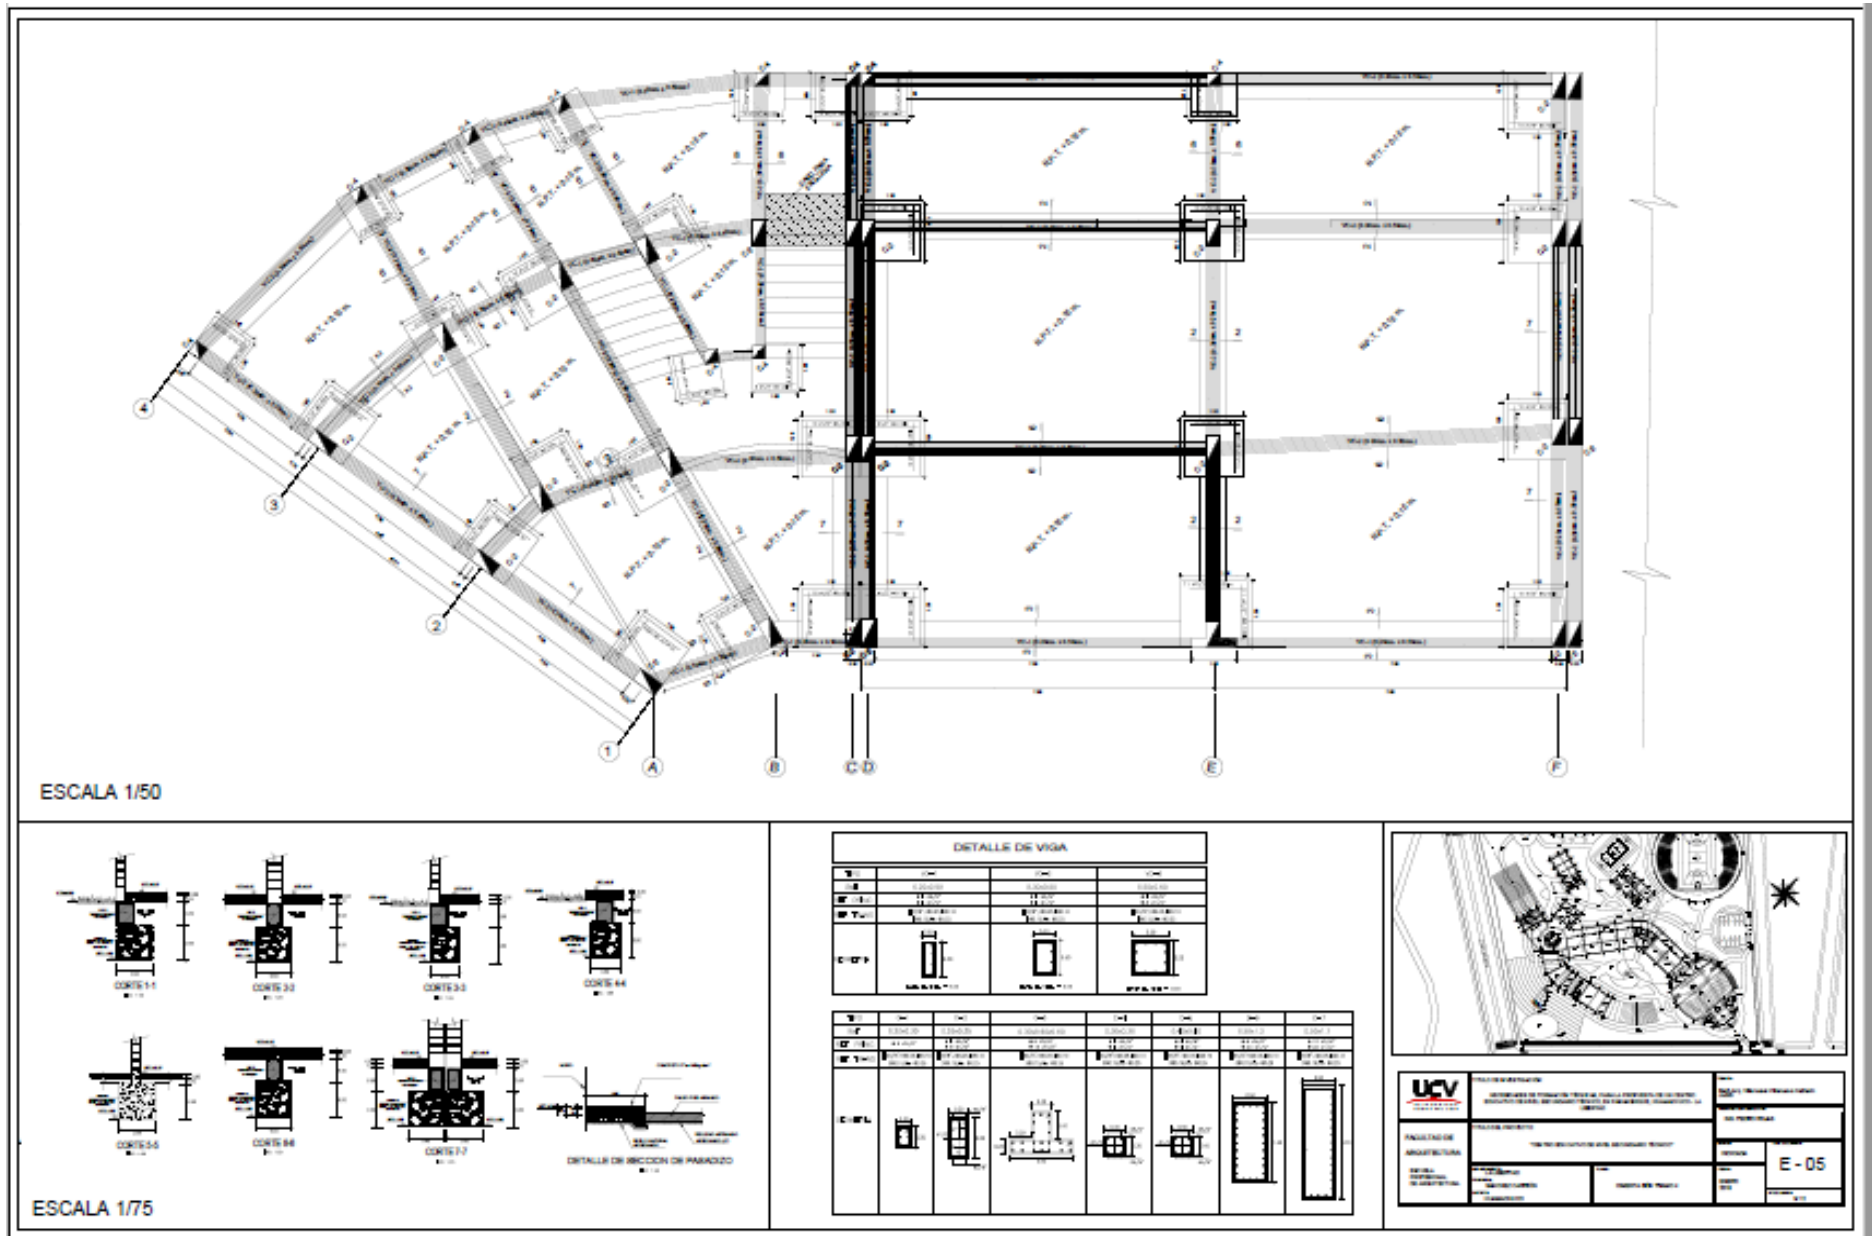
Plano Diseño Estructural Bloque 04 – Cimentación - Plano N° 13 - Lamina E-05
